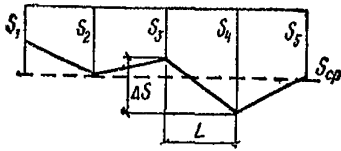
Схема осадок оснований фундаментов здания (сооружения). $\Delta s/L$ — относительная неравномерность осадок двух фундаментов
